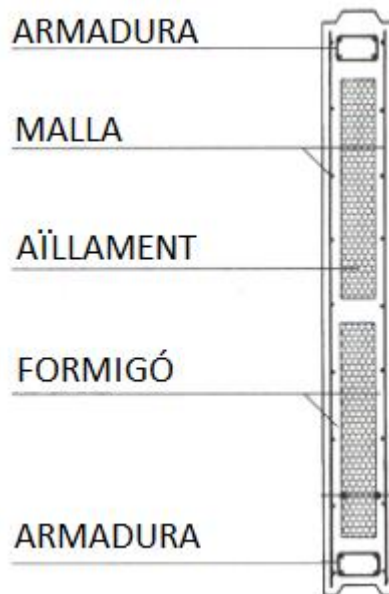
Estructura interna panell façana formigó prefabricat. (Font: "Apunts 3.- Cerramientos exteriores. Fachadas" [15])
